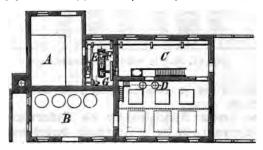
Srundriß einer Extractionsanlage. A Keffelhaus, B Dels ftänder und Raffination, C Mühlenraum, Fahrstuhl oder Transporteur, D Extractionsraum.
